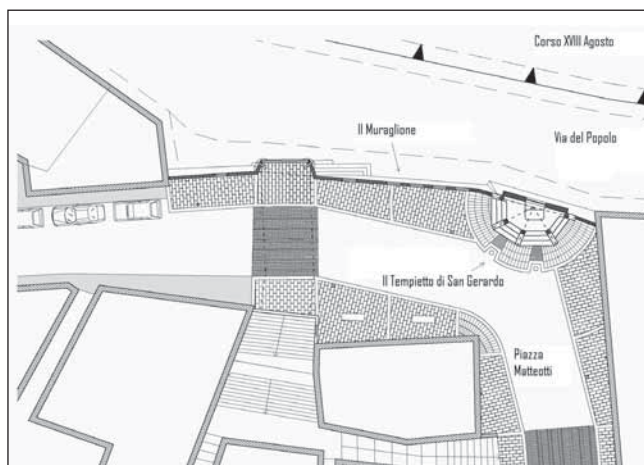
Pianta dell’area in cui sorge il Tempietto.
